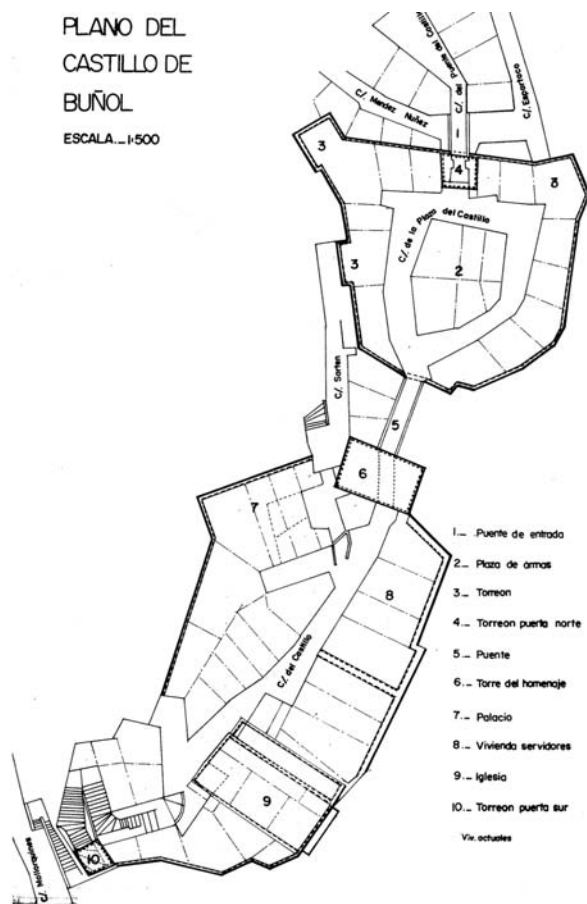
1961. Primer Levantamiento del Castillo. Rafael Tomás
